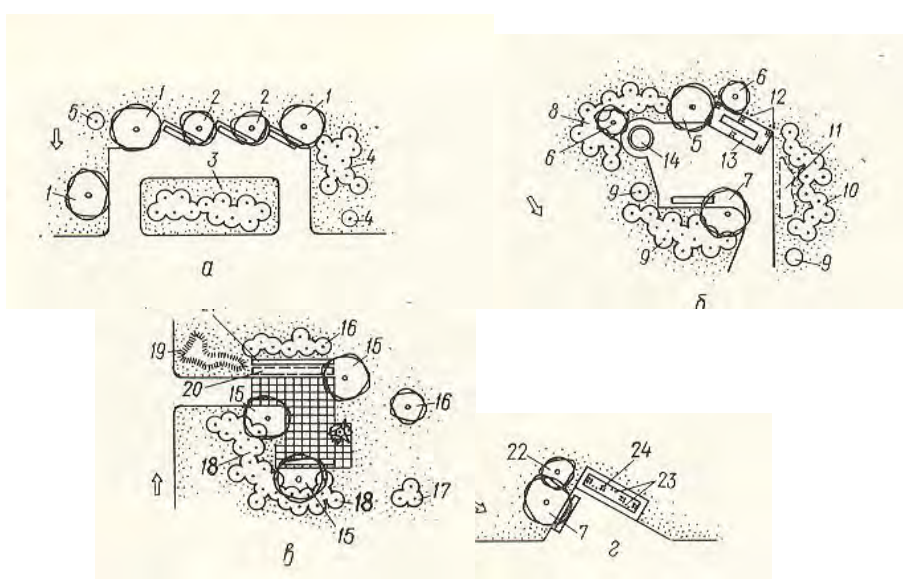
Приемы организации насаждений у площадок отдыха на жилых территориях: а, в – полузакрытая площадка; б – закрытая площадка; г – открытая площадка; 1 – клён-явор; 2- ива плакучая; 3 – чубушник обыкновенный; 4 - шиповник (роза собачья); 5 – дуб красный; 6 – берёза бумажная; 7 – клён остролистный; 8 – жимолость татарская; 9 – спирея Вангутта; 10 – форзиция промежуточная; 11 – флокс метельчатый; 12 - виноград душистый; 13 – пергола; 14 – декоративный бассейн; 15 – липа крымская; 16 – рябина обыкновенная; 17 – калина обыкновенная; 18 – бирючина; 19 – можжевельник казацкий; 20 – гвоздика многолетняя; 21 – декоративная стенка; 22 – яблоня Недзвецкого; 23 – жимолость каприфоль; 24 – трельяж, покрытый листвой лиан
